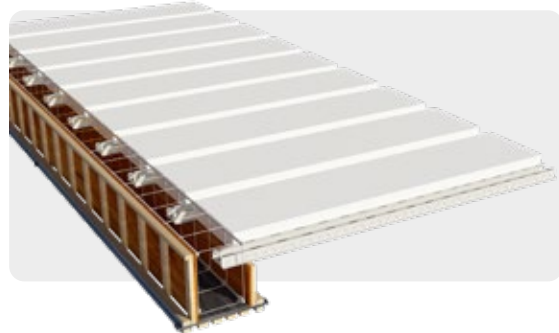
Detalhe de montagem em estrutura de concreto armado
